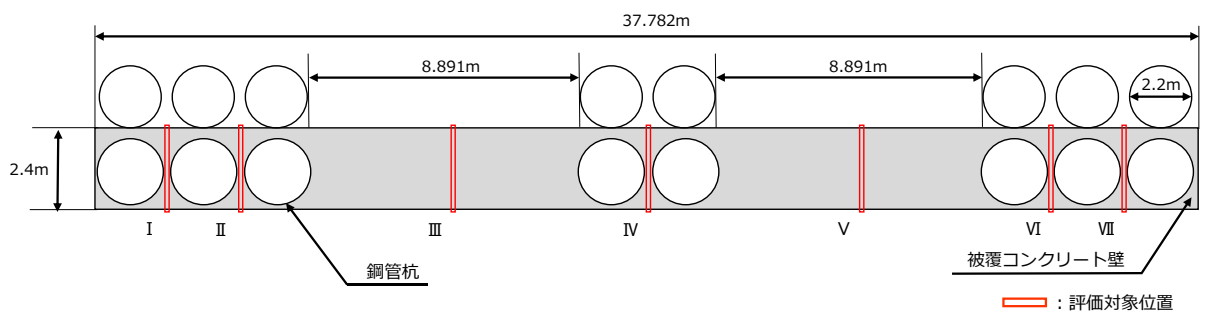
(3) 評価対象位置図 (④-④断面 平面図)
